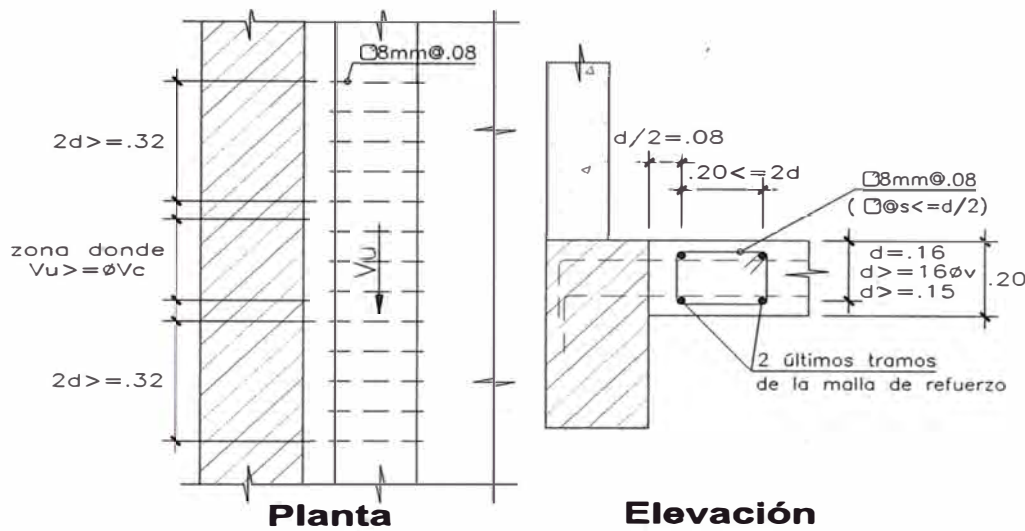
Distribución del refuerzo por cortante en la losa maciza (m)
